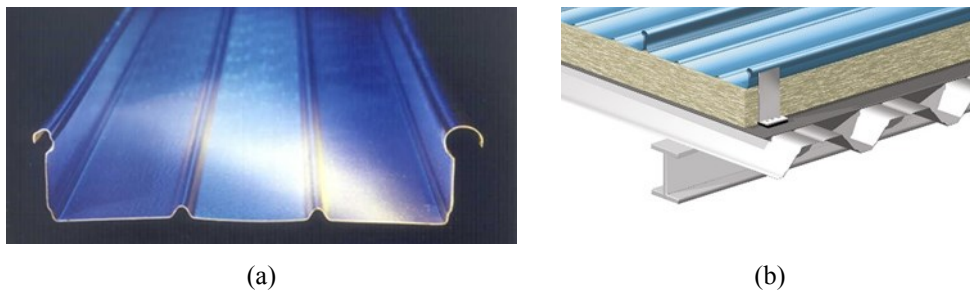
Profilquerschnitt „Kalzip 65“ [7] (a); Befestigung der Elemente [7] (b)
